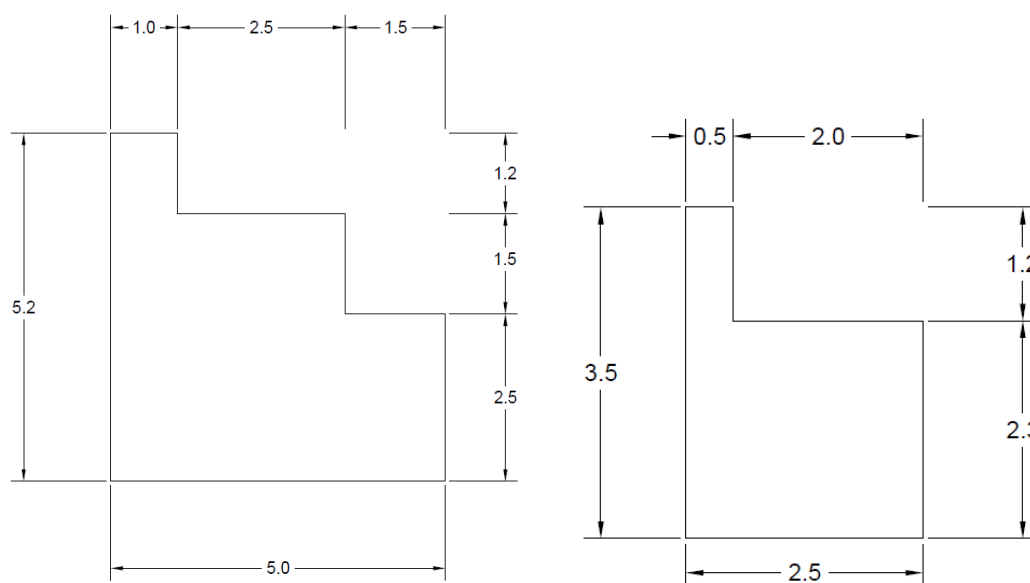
Croquis de la geometría del espaldón en sección 1 a la izquierda y sección 2 a la derecha.
